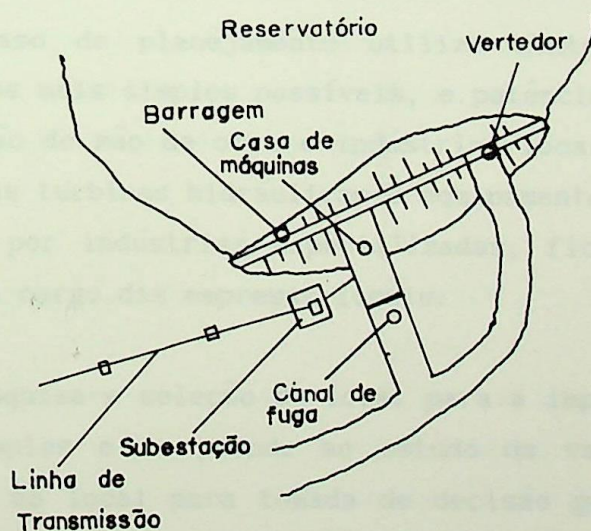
Arranjo básico de PCH de baixa queda com turbina axial
